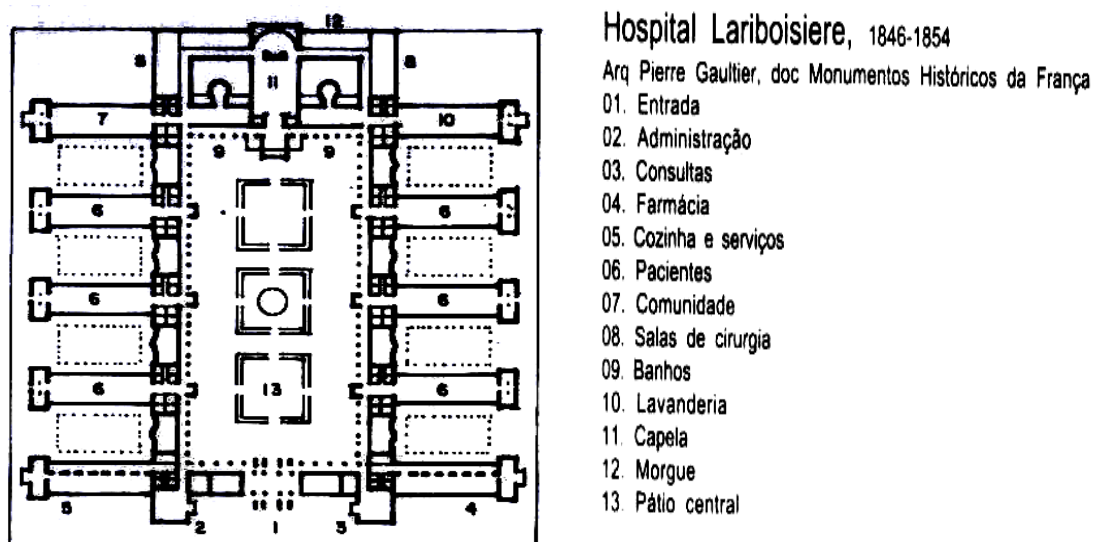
Planta geral do Hospital Lariboisière de Paris projetado por Gauthier em 1839.
